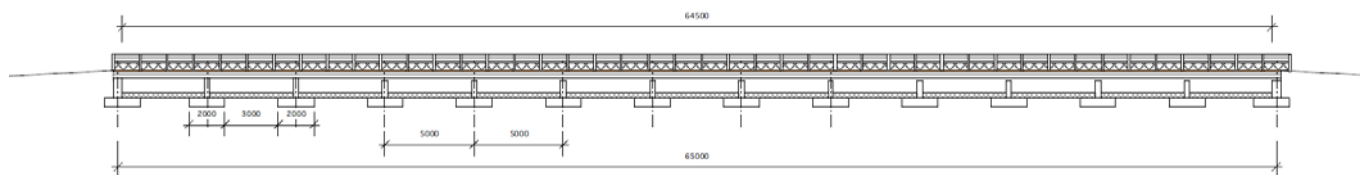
profil vue en élévation de la passerelle sur ouvrage amont depuis l'extérieur du parc
